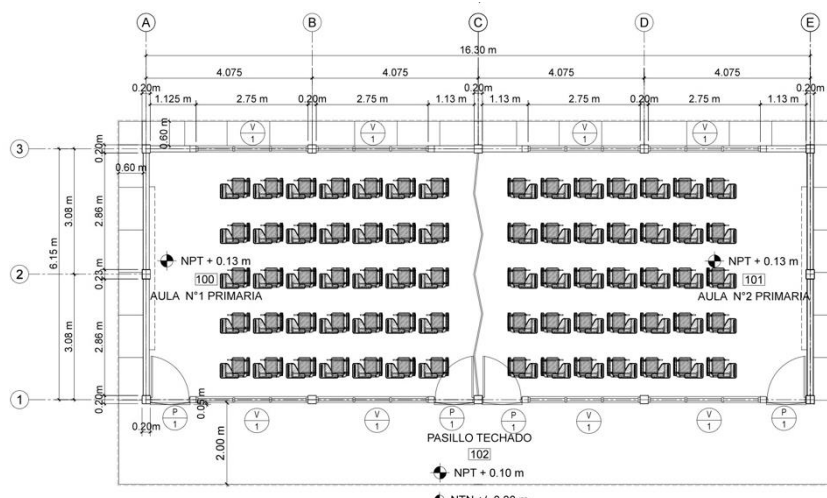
Planta Arquitectónica del Pabellón 2, Fuente: Área de Preinversión MINED
